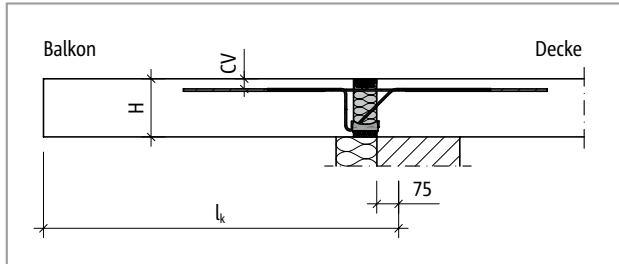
Schöck Isokorb® T Typ K-M1 bis M11: Statisches System
